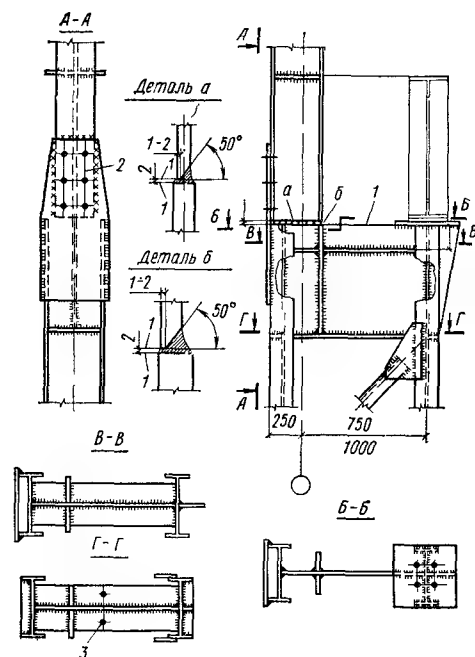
Сопрежение надкрановой и подкрановой частей ступенчатой колонны крайнего ряда
